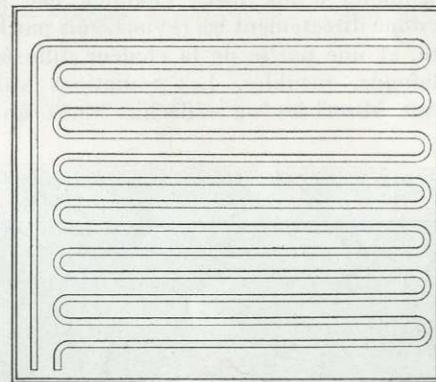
Panneau chauffant constitué par un serpentín noyé dans le sol, le plafond ou le mur.
